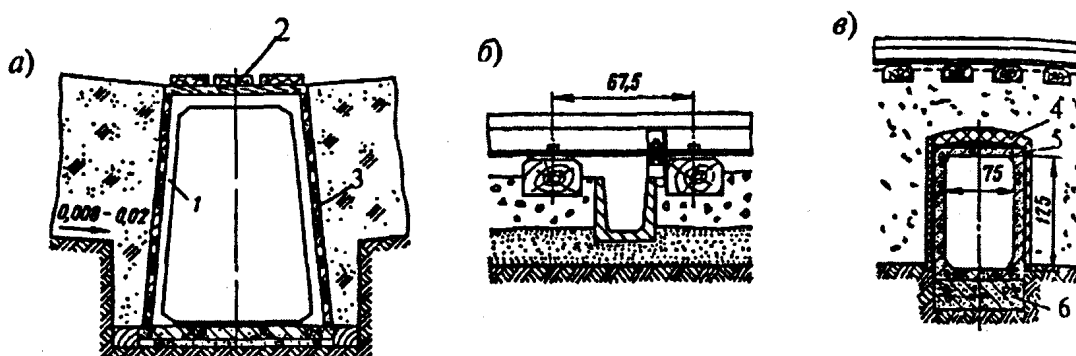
Водоотводные лотки на железнодорожных станциях:
